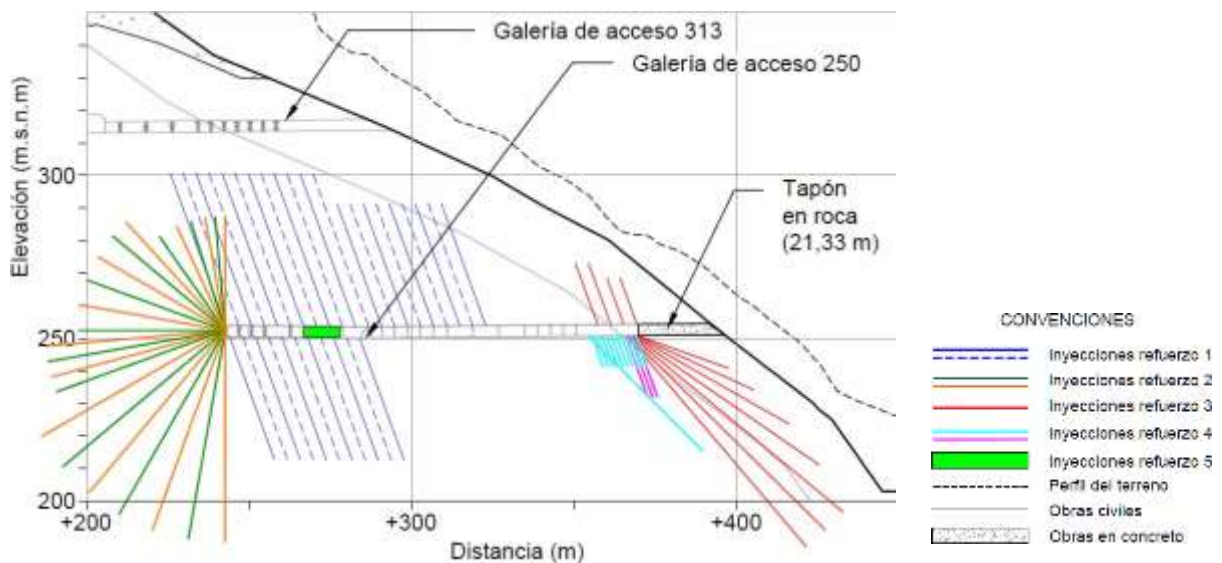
Lechada adicional en estribo izquierdo (de Integral 2019)
